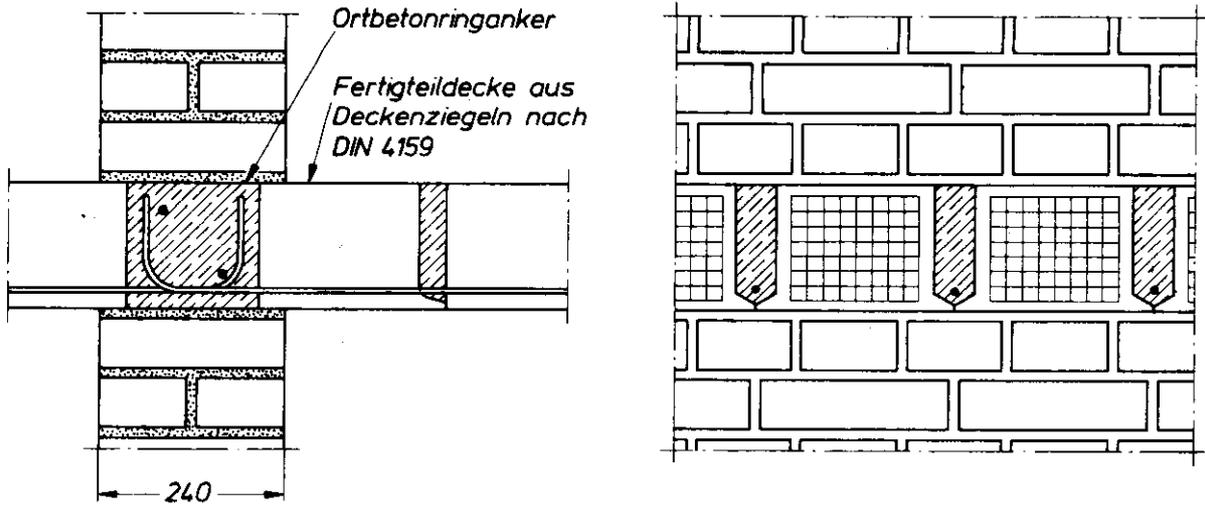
Deckenaufleger aus Ortbeton auf Mauerwerk
